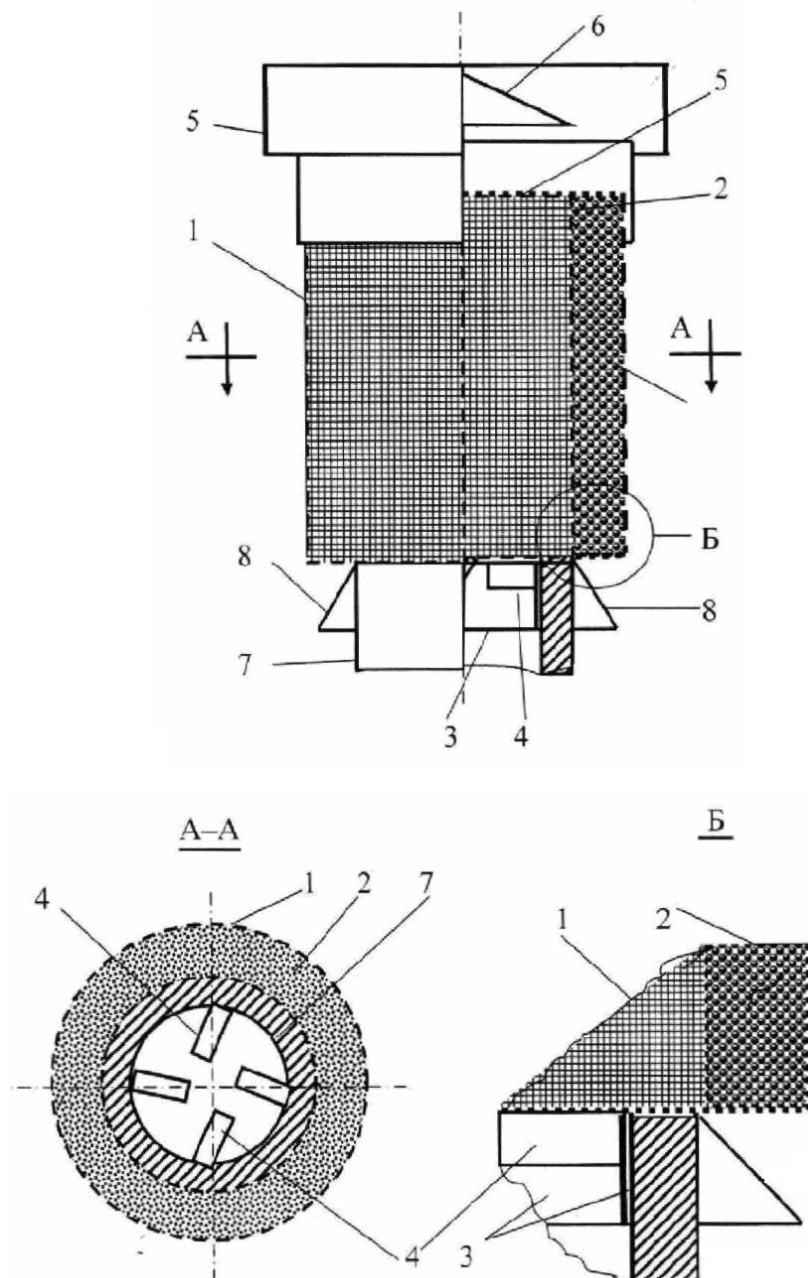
Насадка для дымовой трубы: 1 – вертикальный цилиндрический тороидальный перфорированный патрубок; 2 – гранулы пемзы; 3 – внутреннее вертикальное установочное
